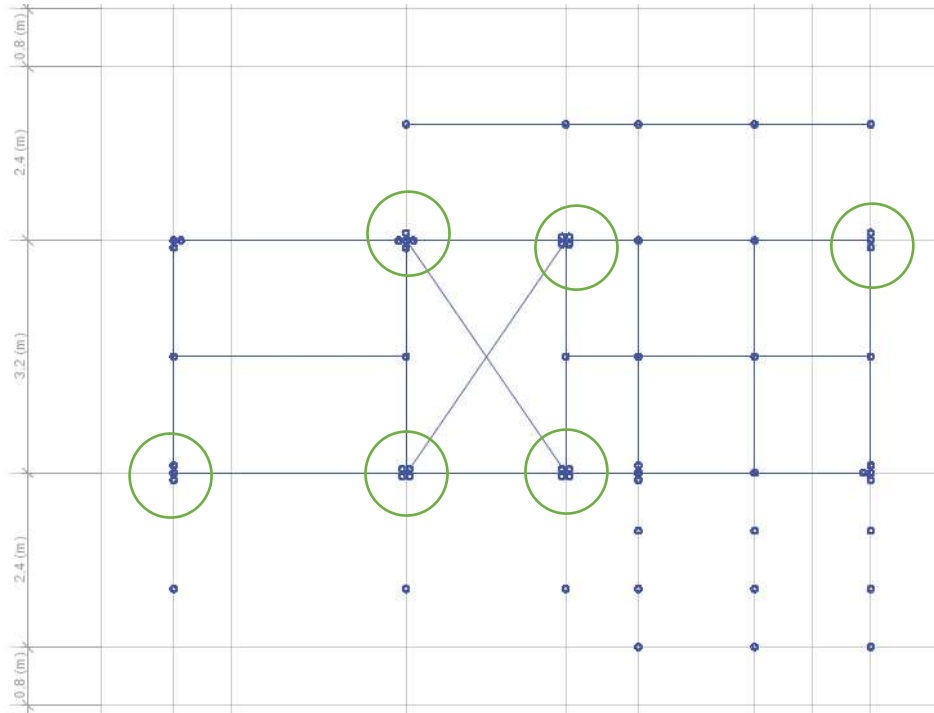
Incremento de secciones de columnas, Vista en Planta $S1=0.51m$.
